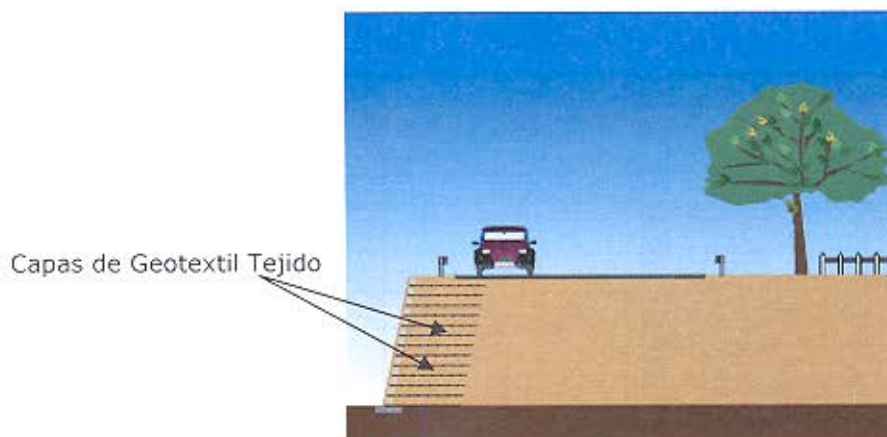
Muro en suelo mecánicamente estabilizado con geosintético
